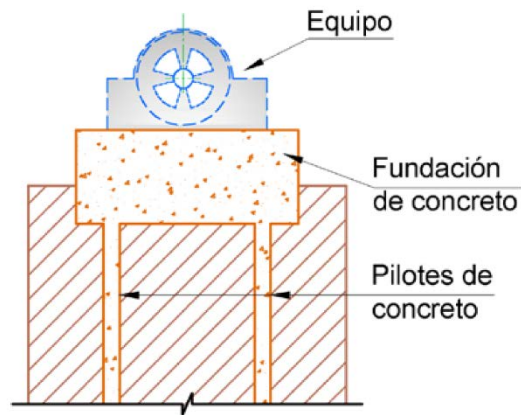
Fundación tipo bloque apoyada sobre pilotes
